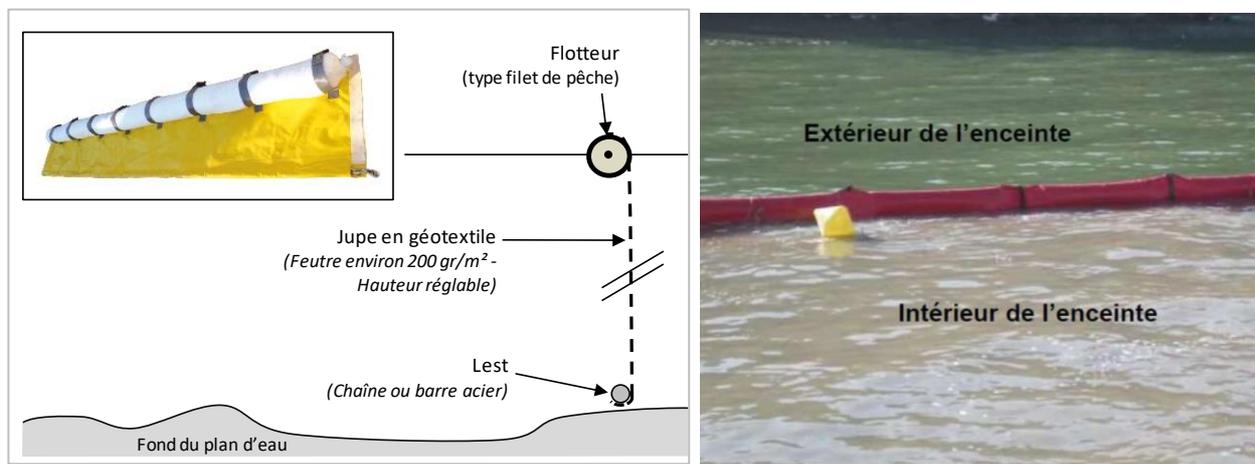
Schéma de principe et photo d'un barrage anti-MES
